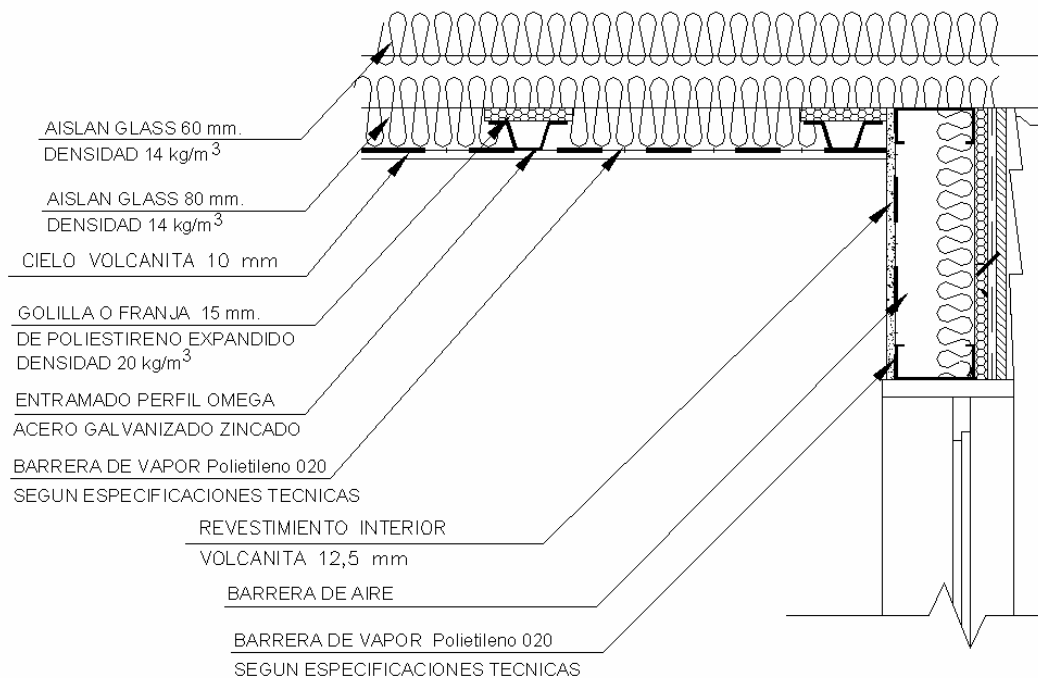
Sistemas de Aislamiento Térmico del Muro Perimetral y Cielo 2º piso de las Viviendas.
